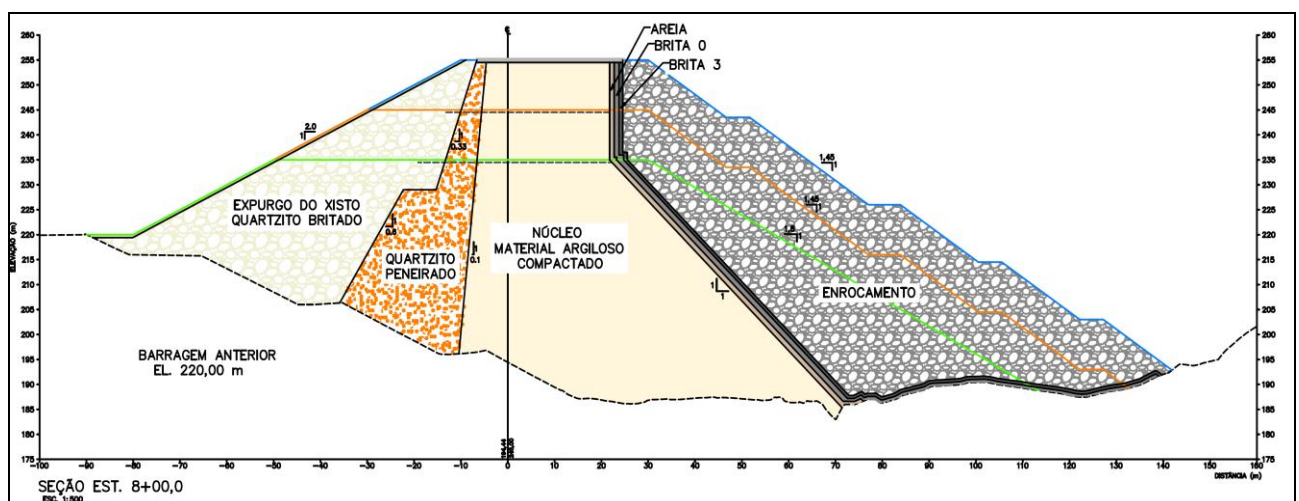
Projeto executivo da Barragem Mirim na elevação 255,0 m
